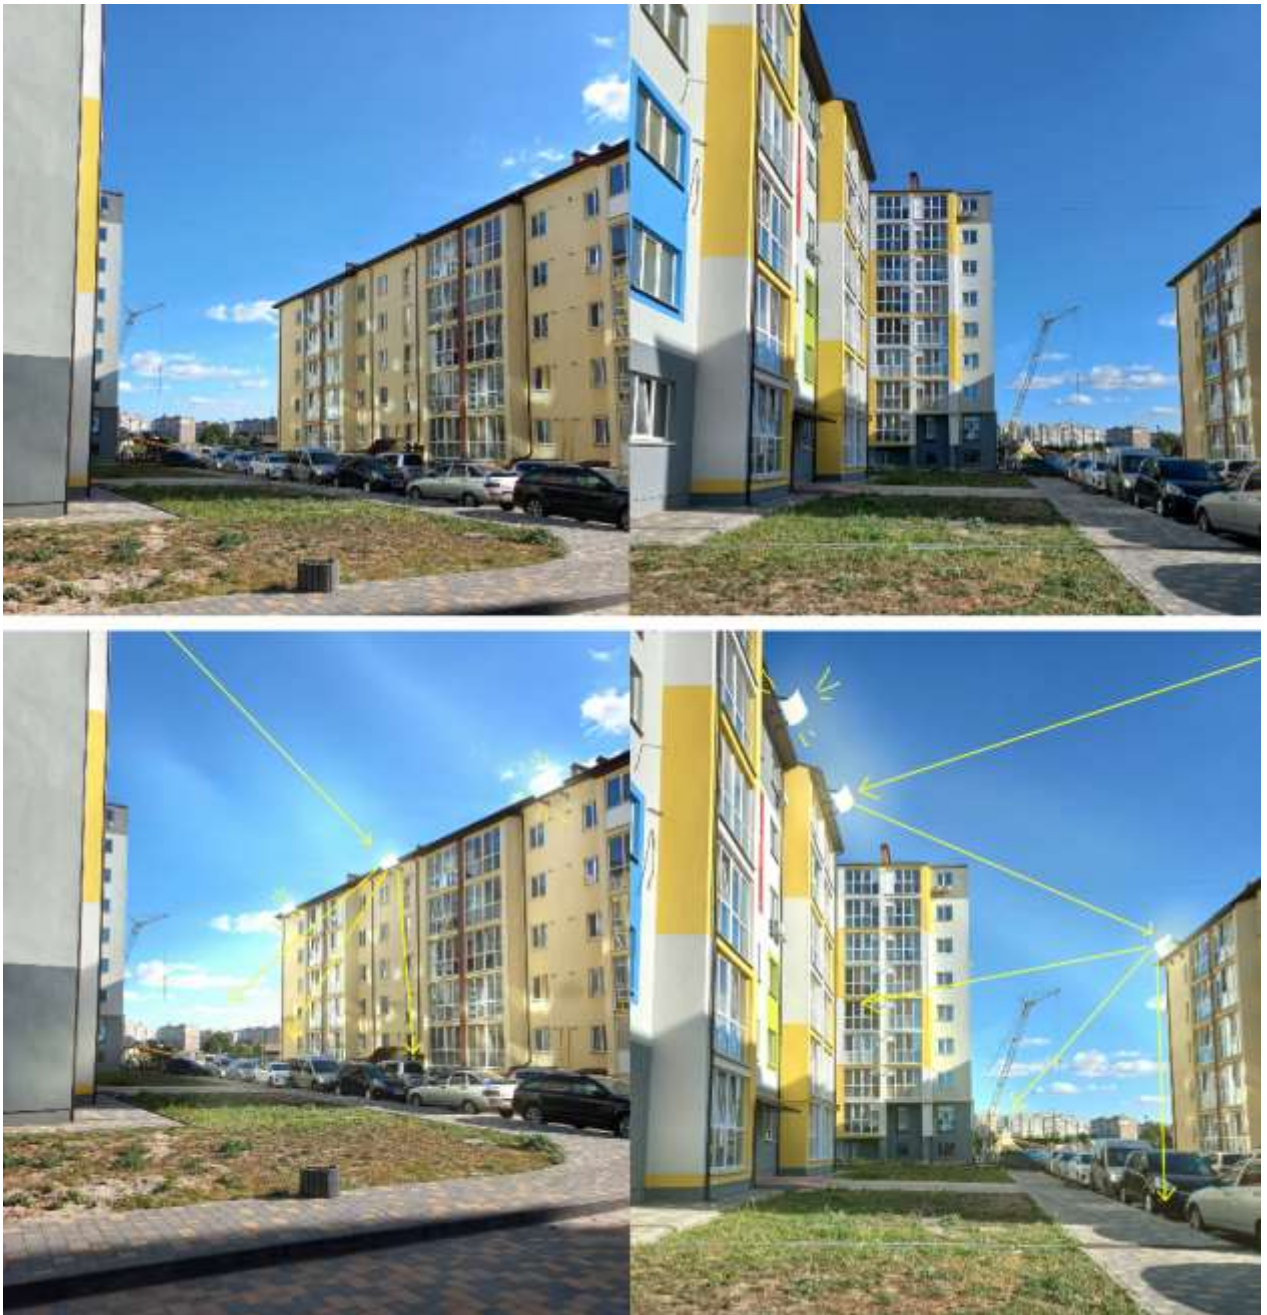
Фасадні дзеркала на фасадах ЖК
